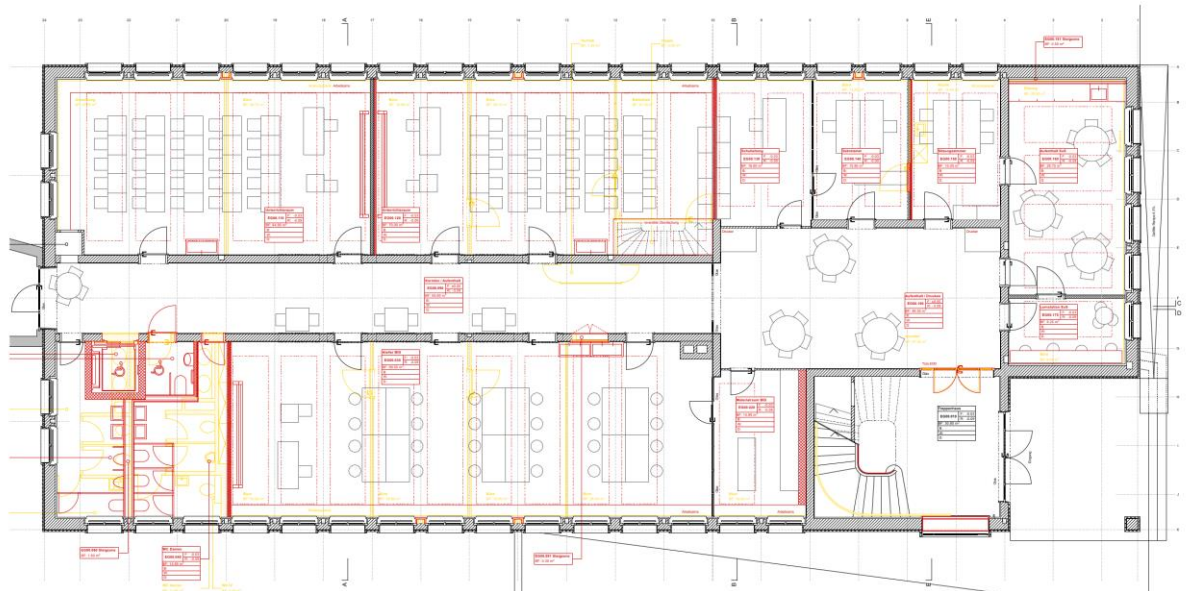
Grundriss UntergeschossAbbildung 2: Grundriss Erdgeschoss
